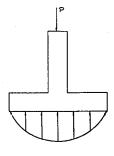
Deformación del estrato de apoyo en una cimentación Flexible.
